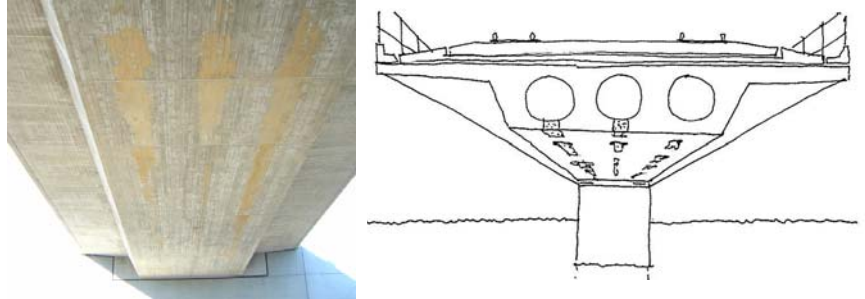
Defectos de ejecución en un puente losa por acumulación de barro y suciedad bajo los aligeramientos, que han impedido un correcto hormigonado.
